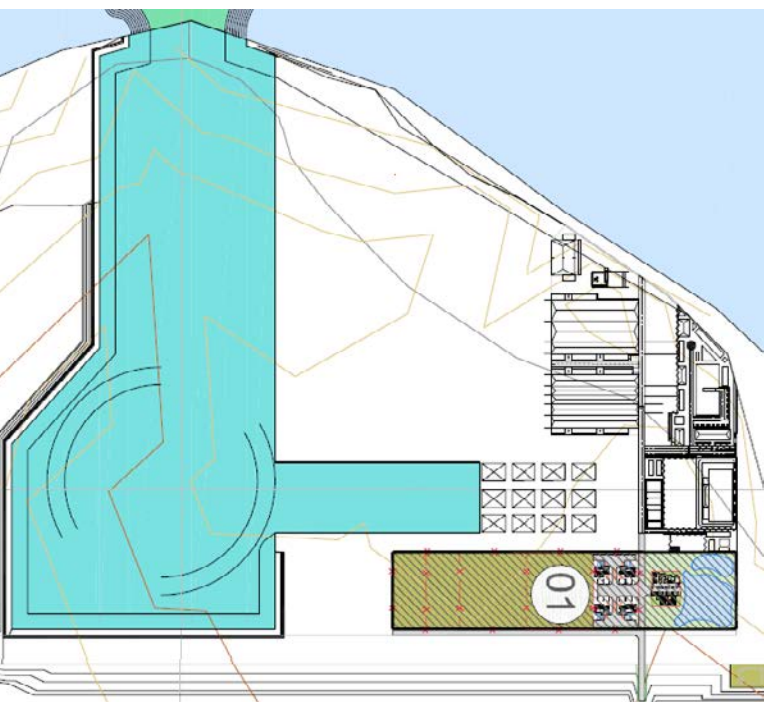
Localização do canteiro de obras a ser utilizado durante a instalação do Estaleiro CMO, evidenciado no item 01 da figura.
